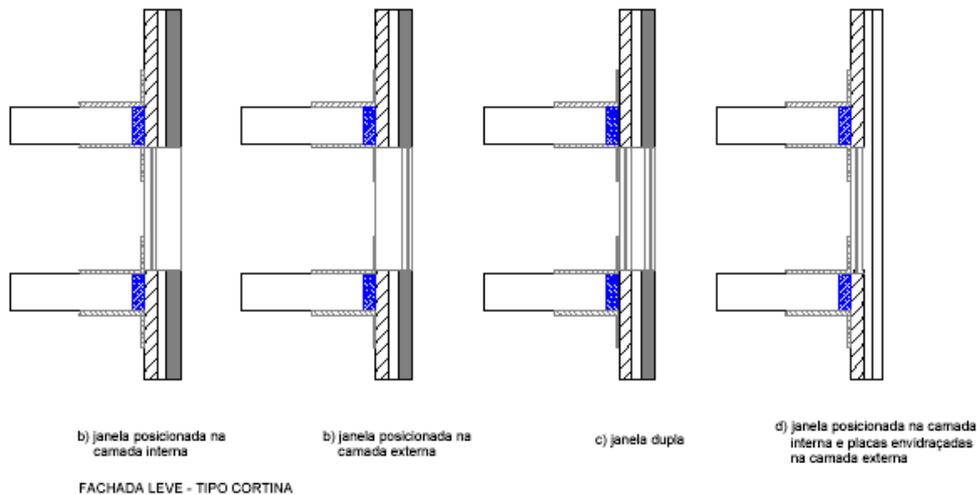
Esquema da secção longitudinal de fachadas-cortina constituída de várias camadas
